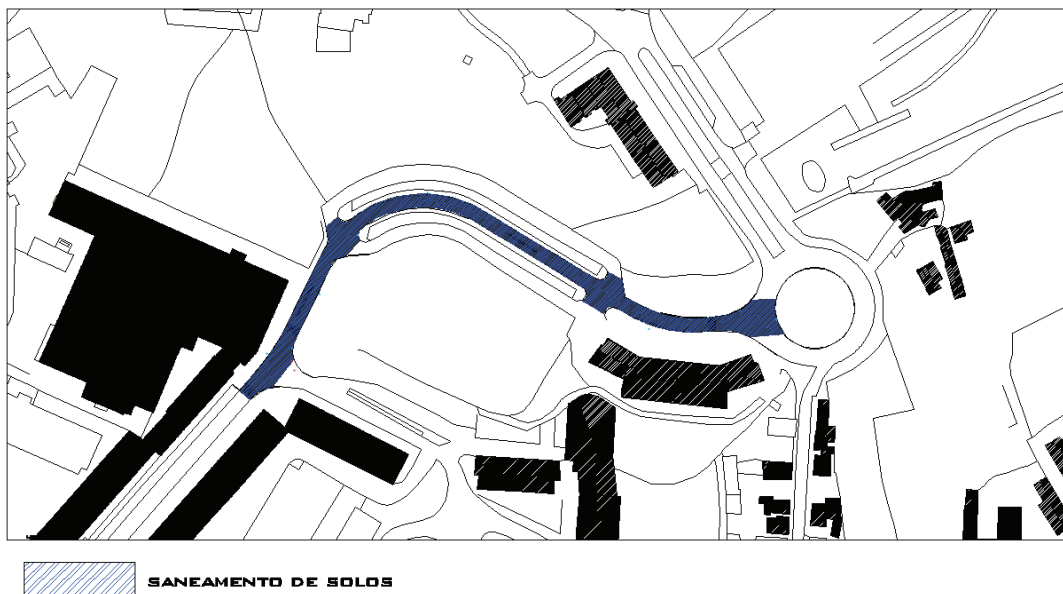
Trabalhos de pavimentação na Rua Cónego Dr. Manuel Faria.
